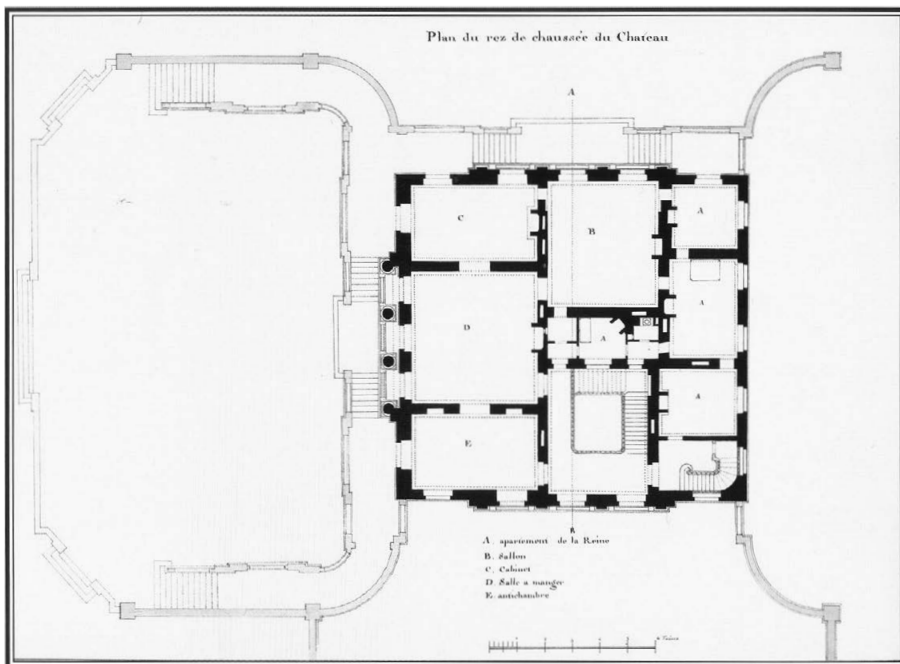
Claude-Louis Châtelet, *Plan du rez de chaussée du Château [Petit Trianon]*, Detail, 1786, Tusche, 31,3 × 43 cm, Biblioteca Estense, Modena
